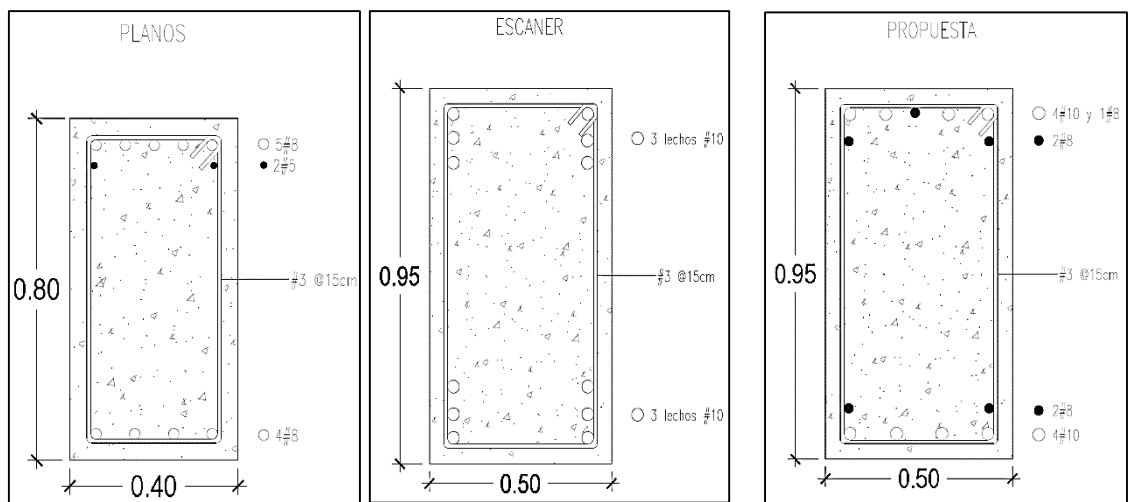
Ejemplo de armado propuesto para una de las vigas de la edificación en estudio.
